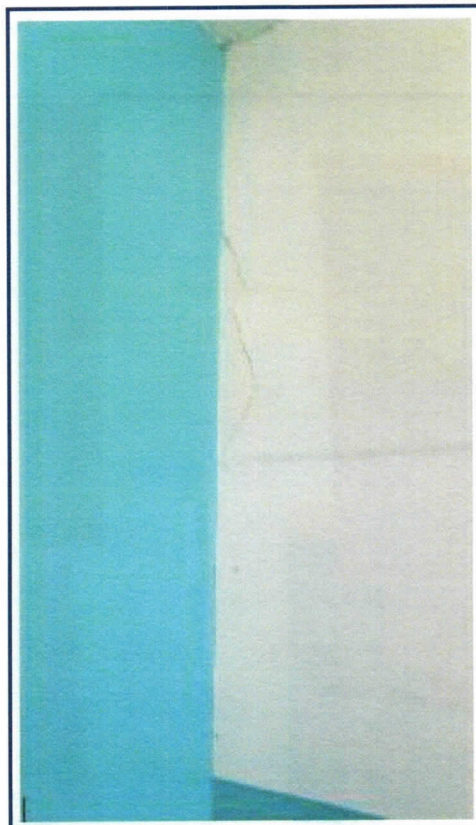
Vista da parede de alvenaria com trinca vertical, ao lado da porta, anterior ao incêndio.
